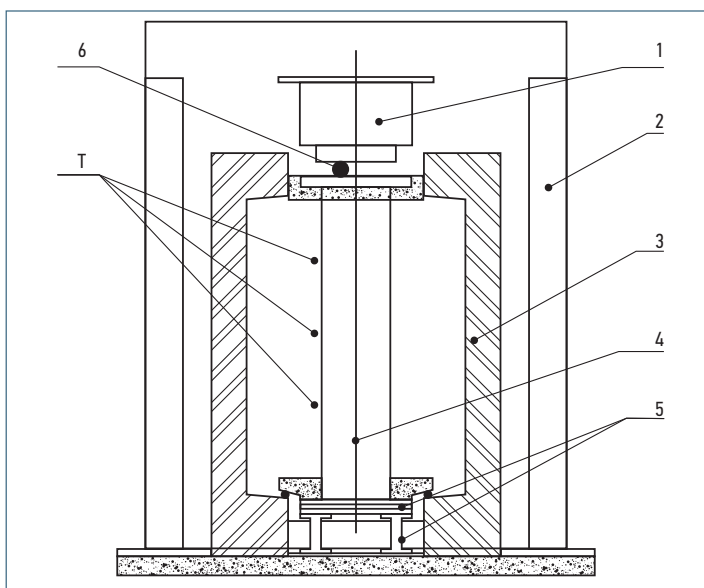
Пример расположения образца колонны, испытываемой под нагрузкой
